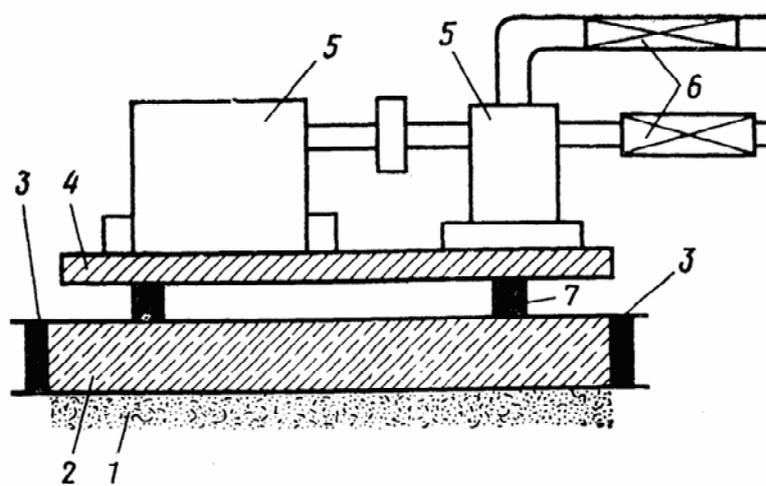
Схема звукоизоляции водопроводного насоса:
